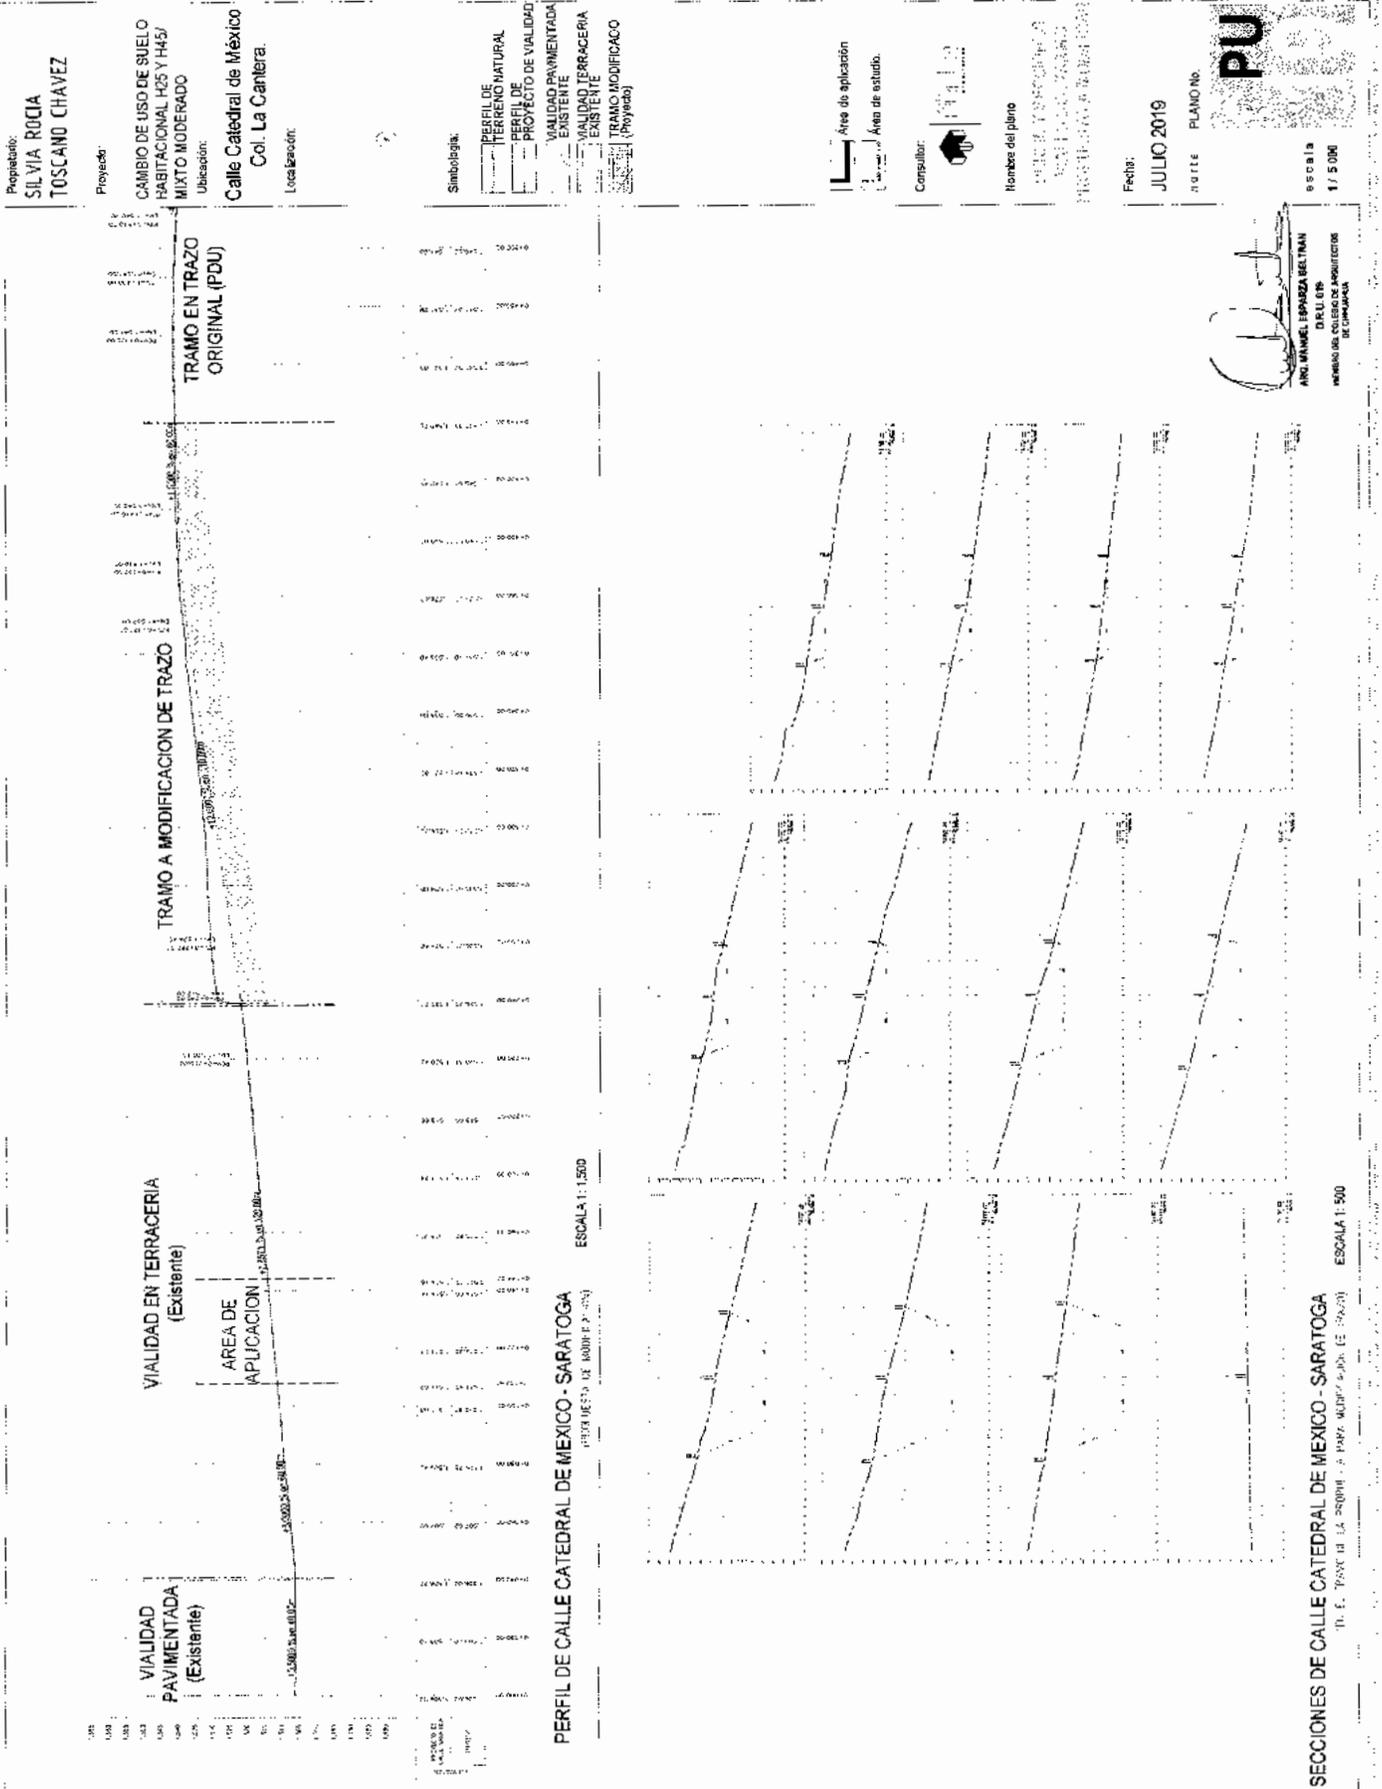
Secciones de vialidad propuesta, en tramo a modificar trazo.
